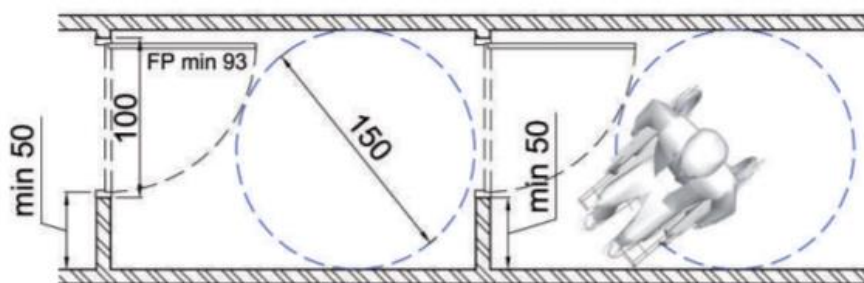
Conception de portes d'intérieur accessible pour tous, Source : Guide d'aide à la construction d'un bâtiment accessible
